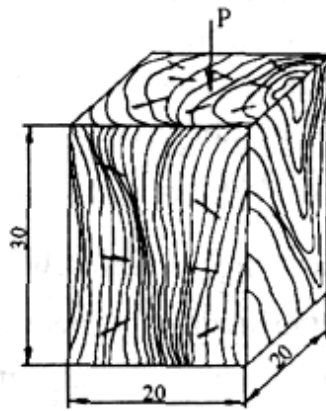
Схема испытания древесины на сжатие вдоль волокон
